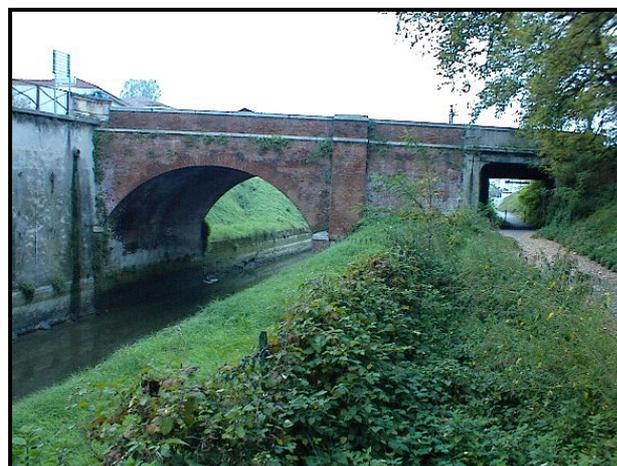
Vista da valle del ponte sul canale Lanza, lungo la strada cittadina.
